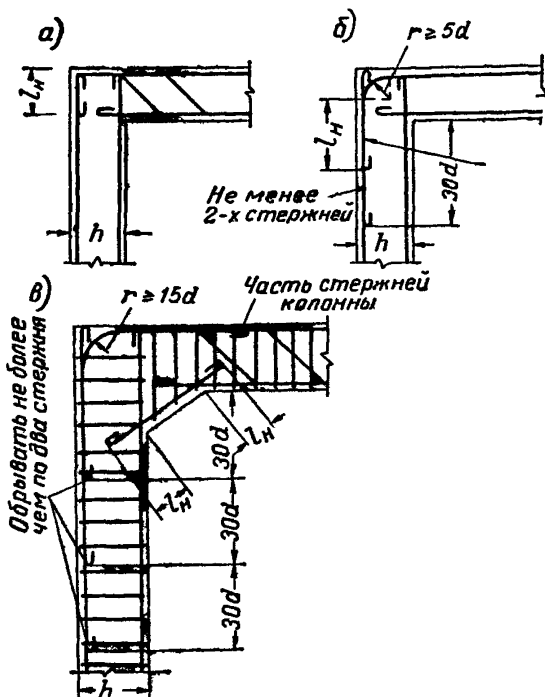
Армирование крайних верхних узлов рам (при применении арматуры периодического профиля на концах стержней крюки не устраивают)
